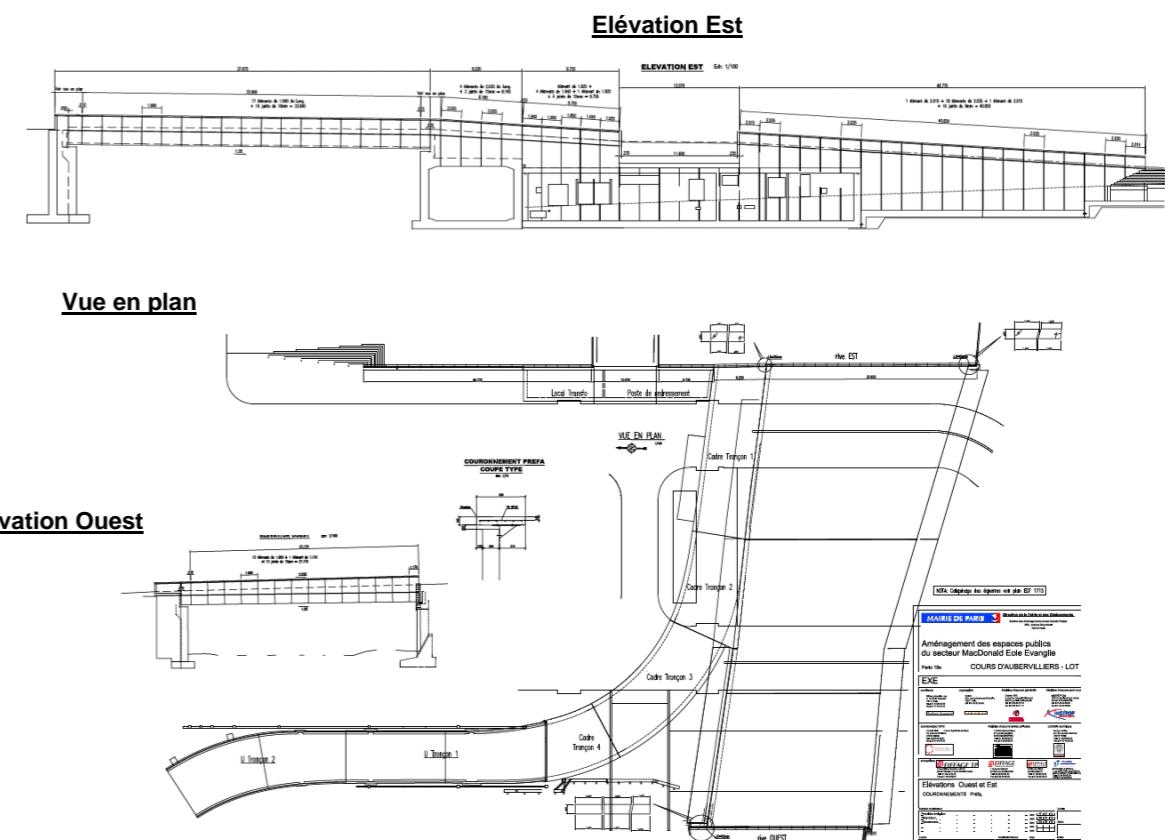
Ouvrage rue d'Aubervilliers – Vue en plan et élévations est et ouest
